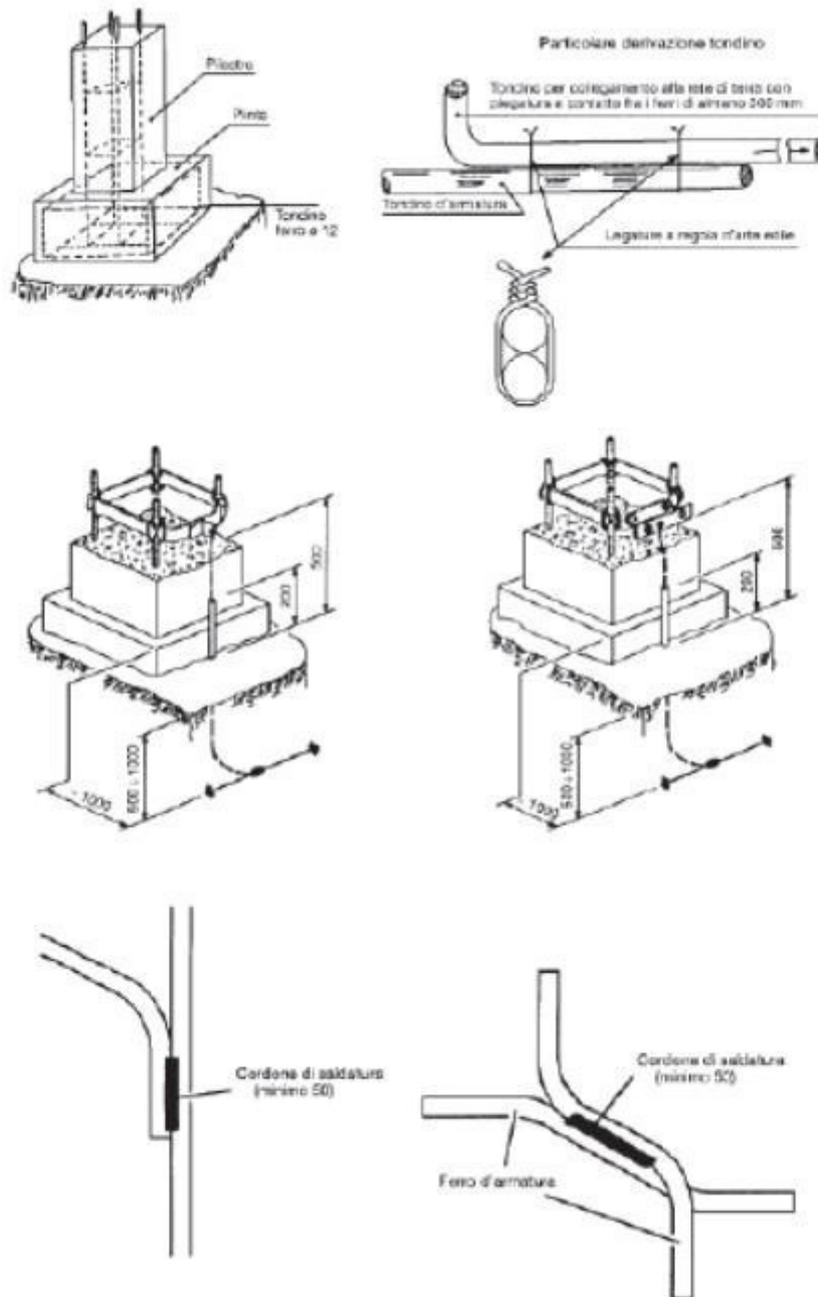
Esempi di plinti di pilastri e di connessioni ai ferri dell'armatura (dimensioni espresse in mm)
